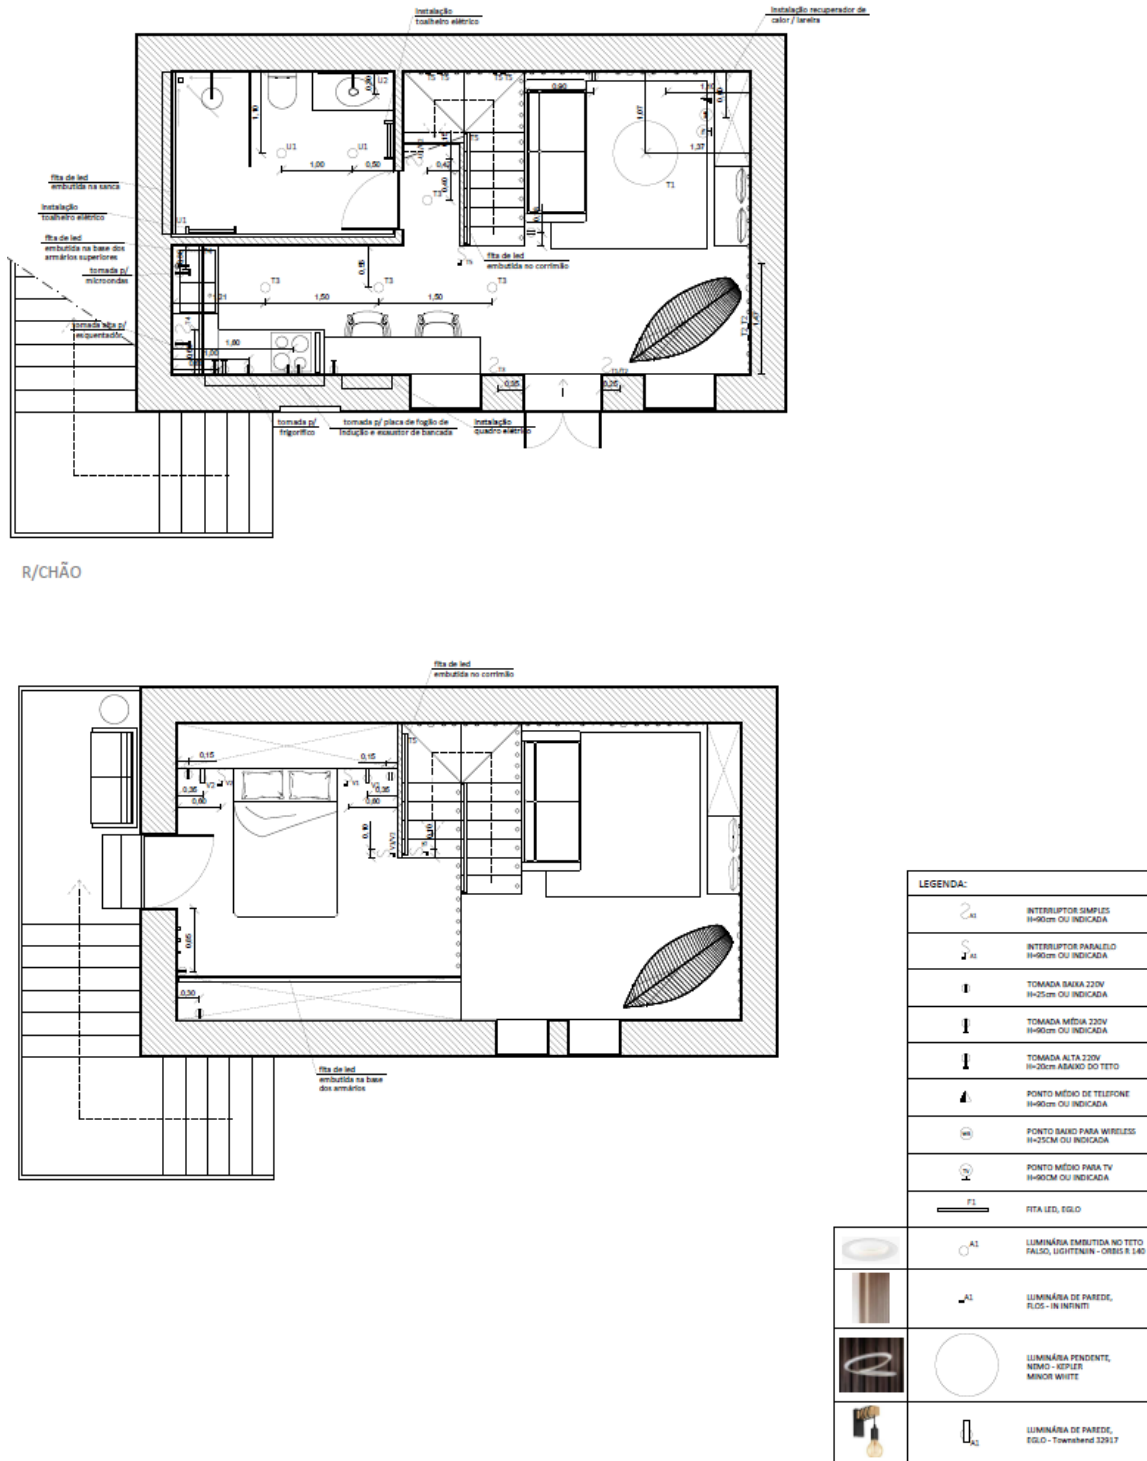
Planta de Iluminação e Tomadas, Alojamento Til.
